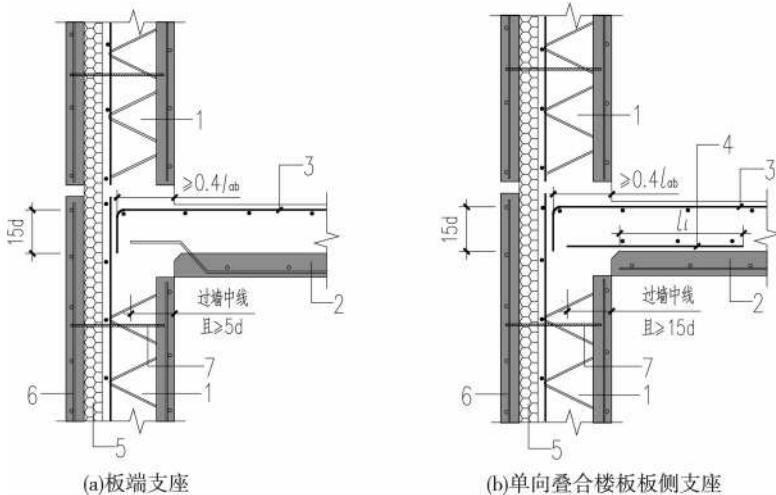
夹心保温单面叠合剪力墙与叠合楼板连接节点构造示意
